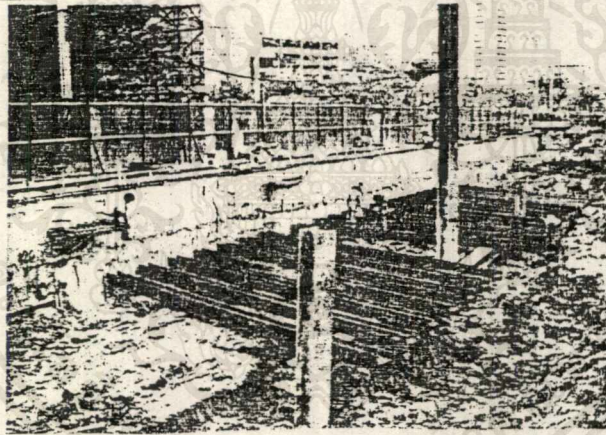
การทำ CAPPING BEAM ไว้ที่ขอบบนของ DIAPHRAGM WALL เพื่อตีร่าง DIAPHRAGM
